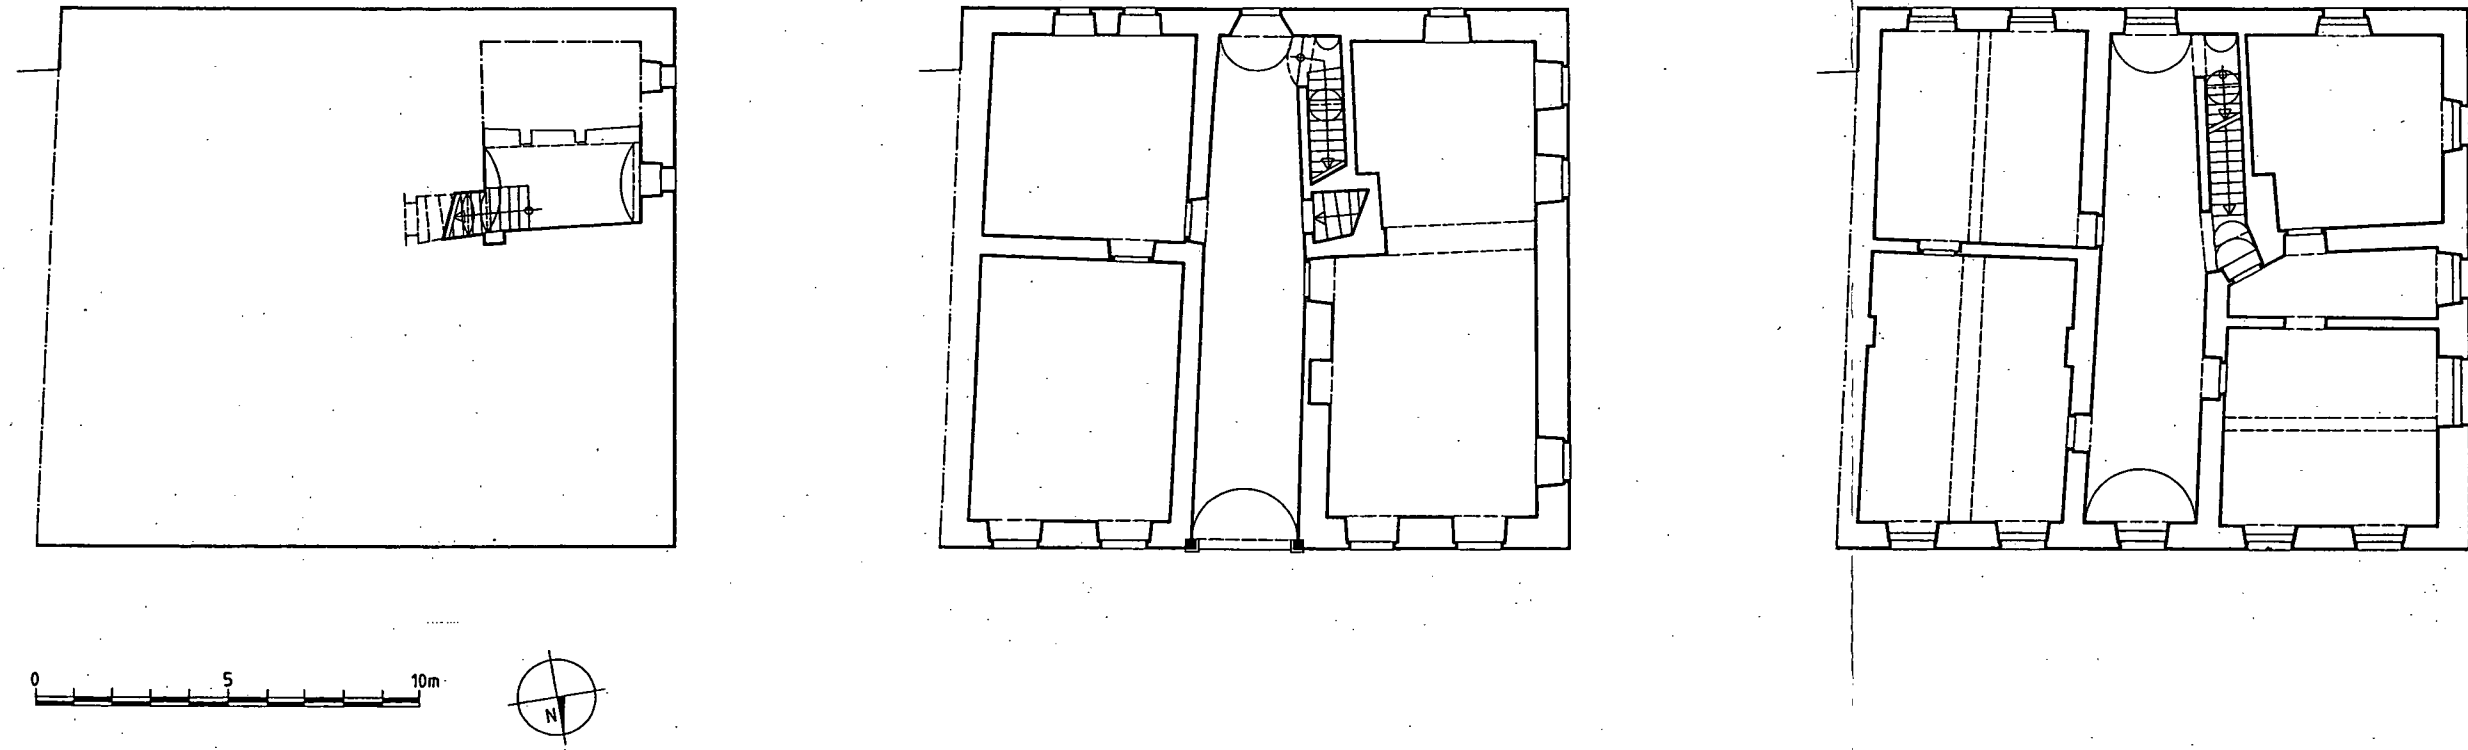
Keplerstraße 3 – Grundrisse Keller, Erdgeschoss, Obergeschoss (1:200).
